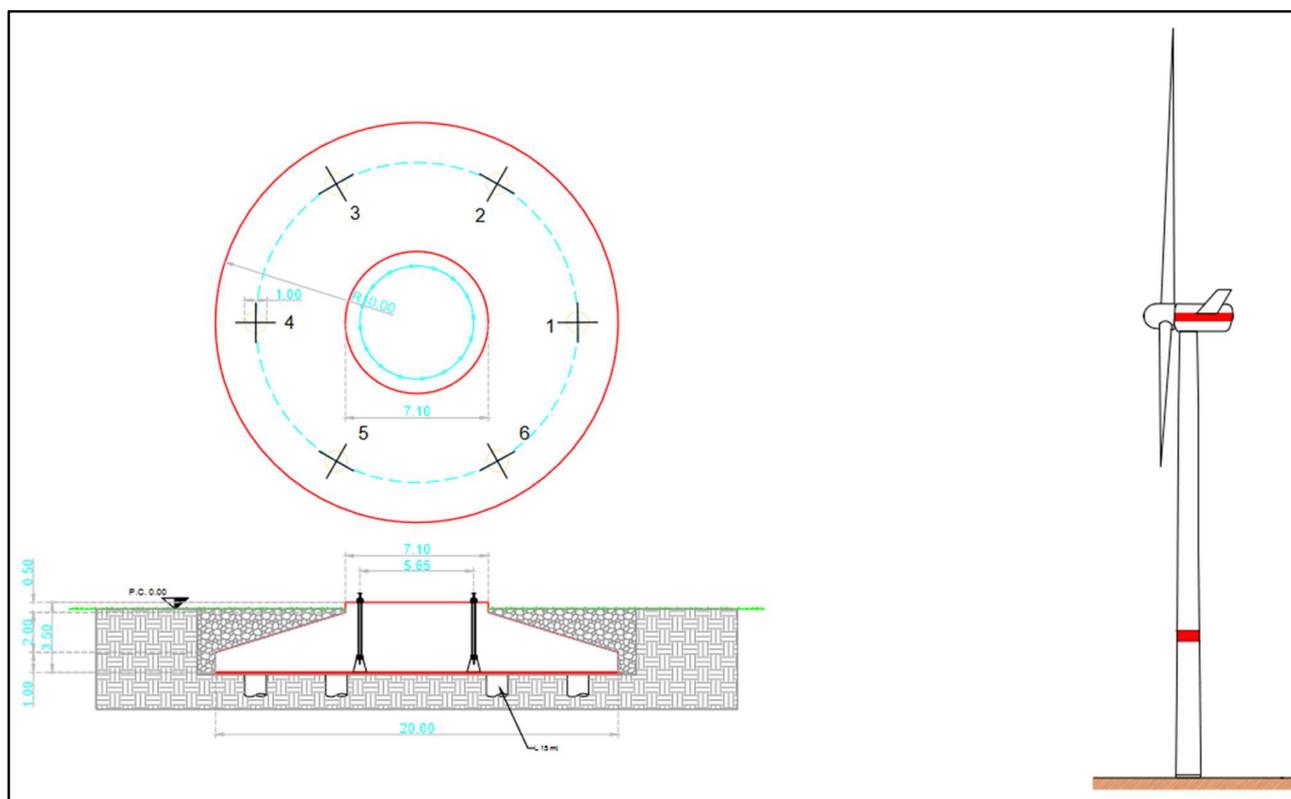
Fondazioni tipo per l'installazione degli aerogeneratori
